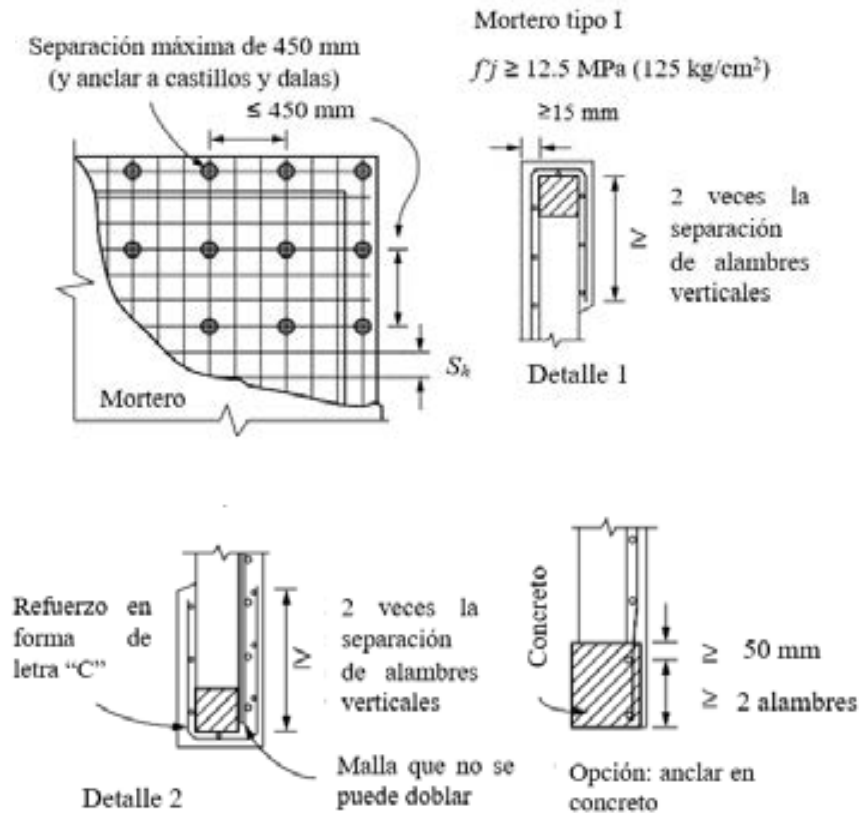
Disposiciones normativas para la colocación de malla de alambre en la superficie de los muros de mampostería (NTC-Mampostería, 2017)
